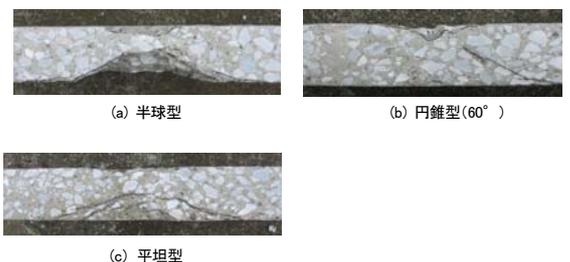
衝突後のコンクリート板断面(200m/s, 板厚 7cm)
